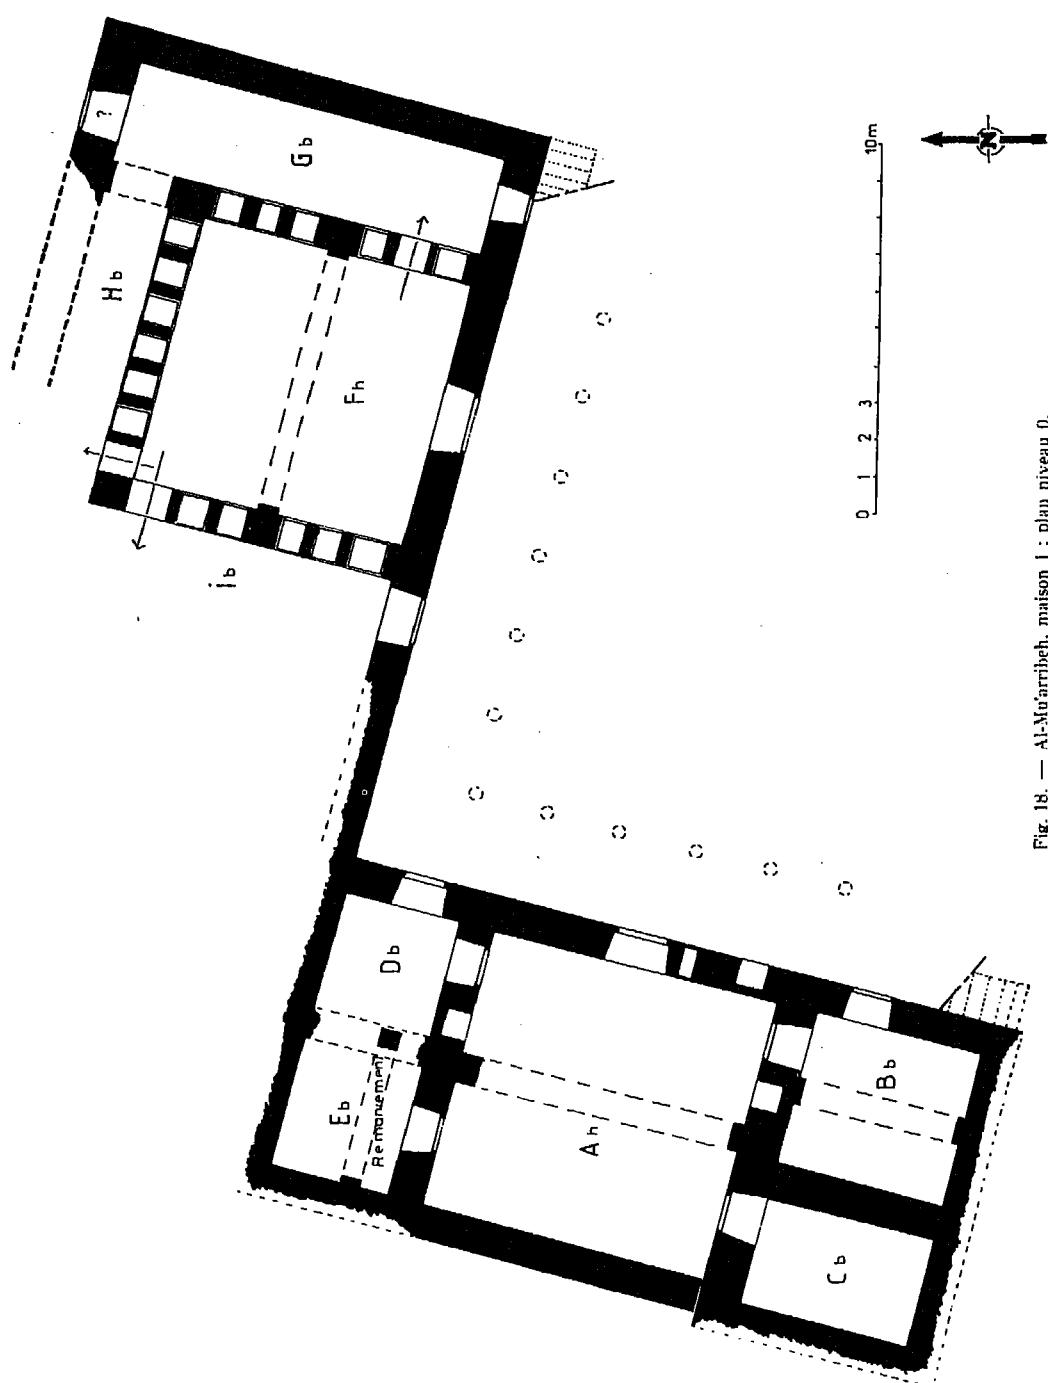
Al-Muarritheh, maison 1 : plan niveau 0.
